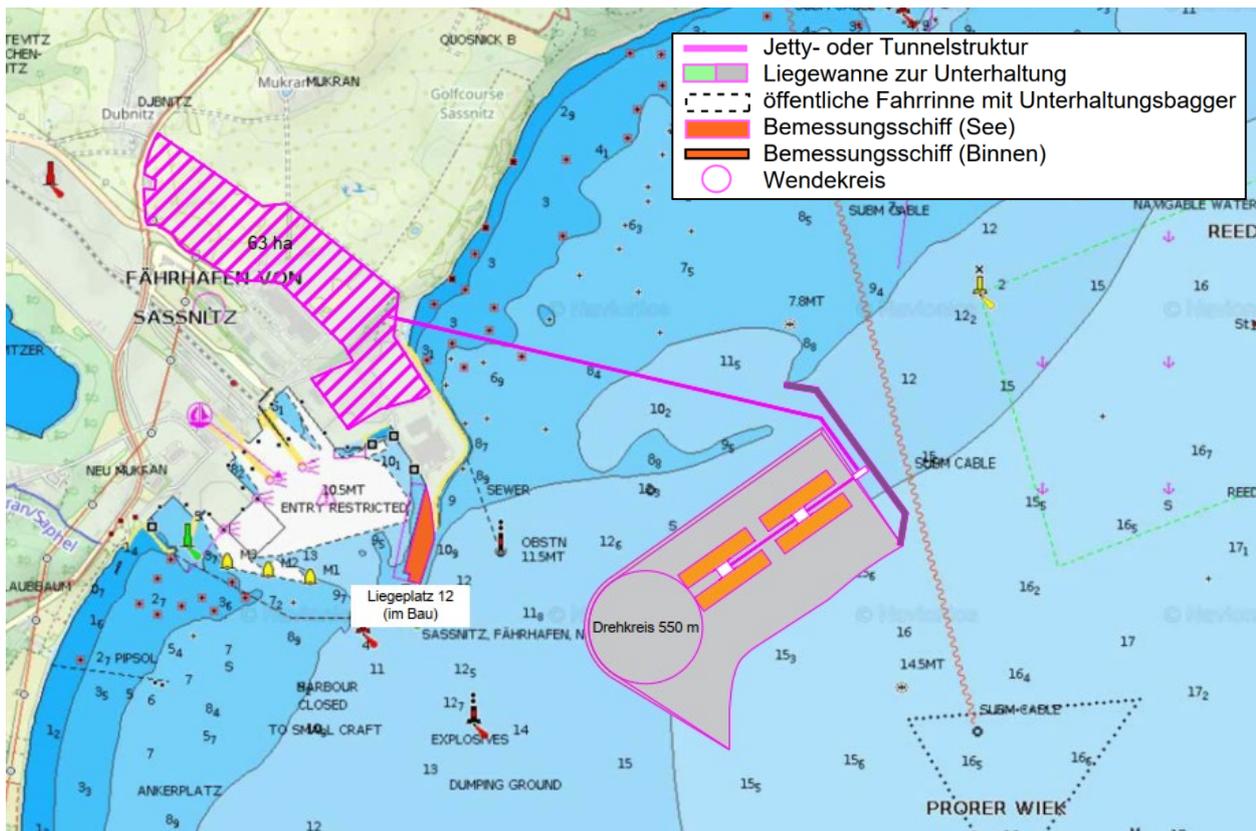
Lageplan Alternative 17: Mukran²⁰³
